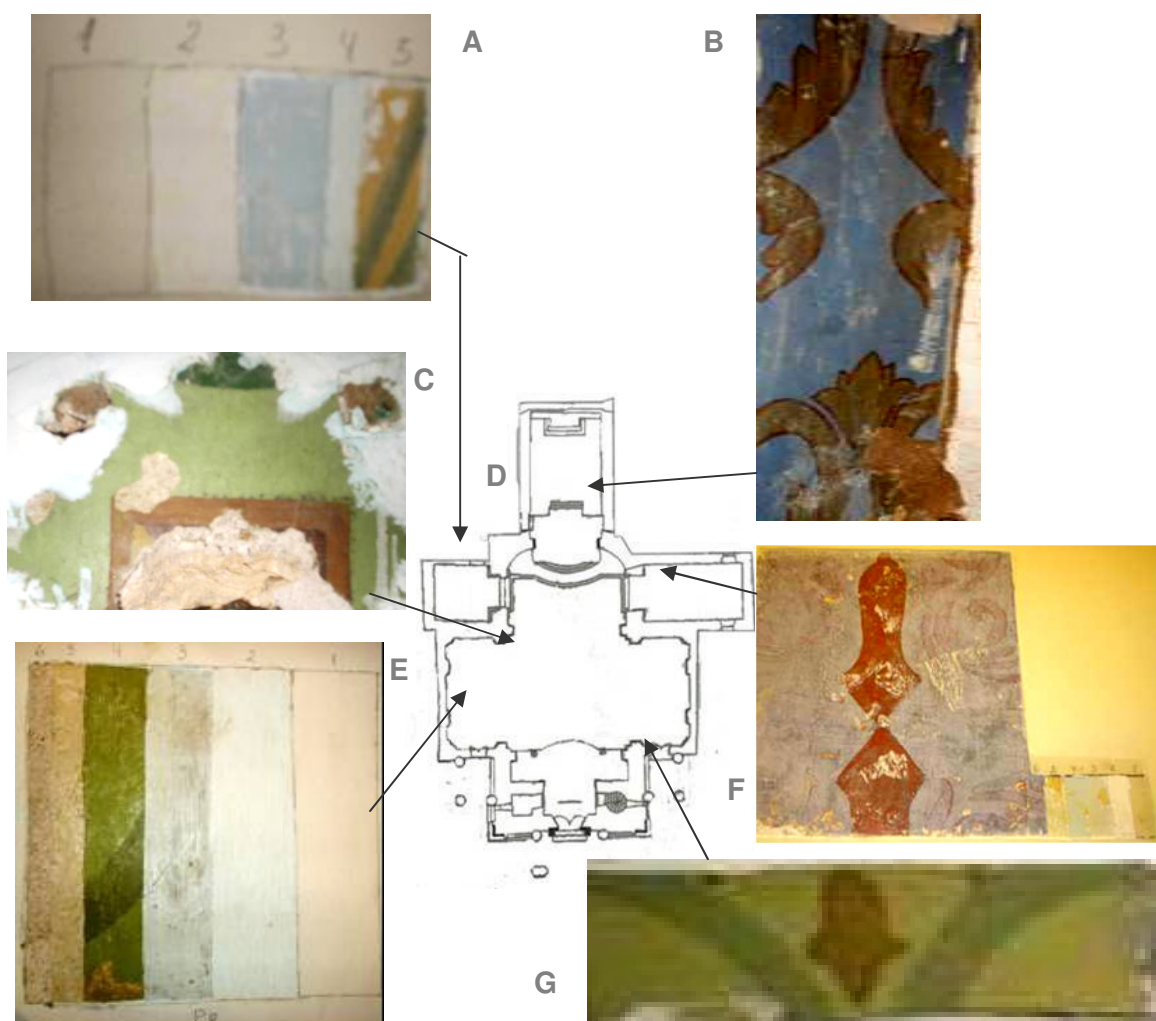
Conjunto de imagens e planta localizando as prospecções das pinturas murais.
